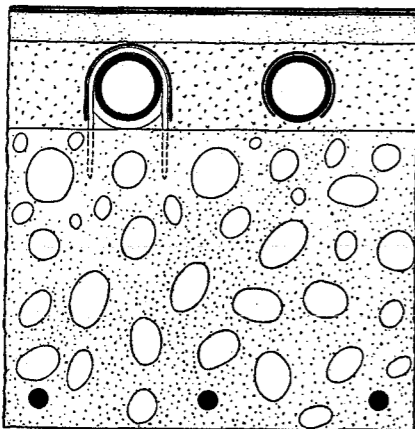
Sprinklerrør liggende ovenpaa Jernbetondæk og omstøbt med en Specialmørtel.
